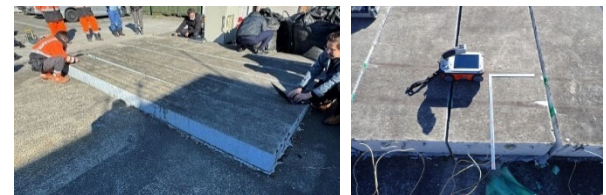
試験体の配置状況と測定状況 (屋外暴露)
